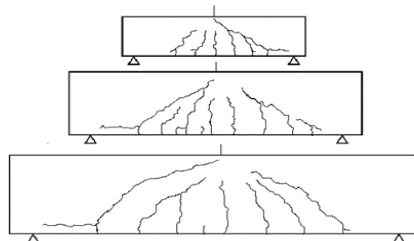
Profils de fissurations pour les trois poutres.
